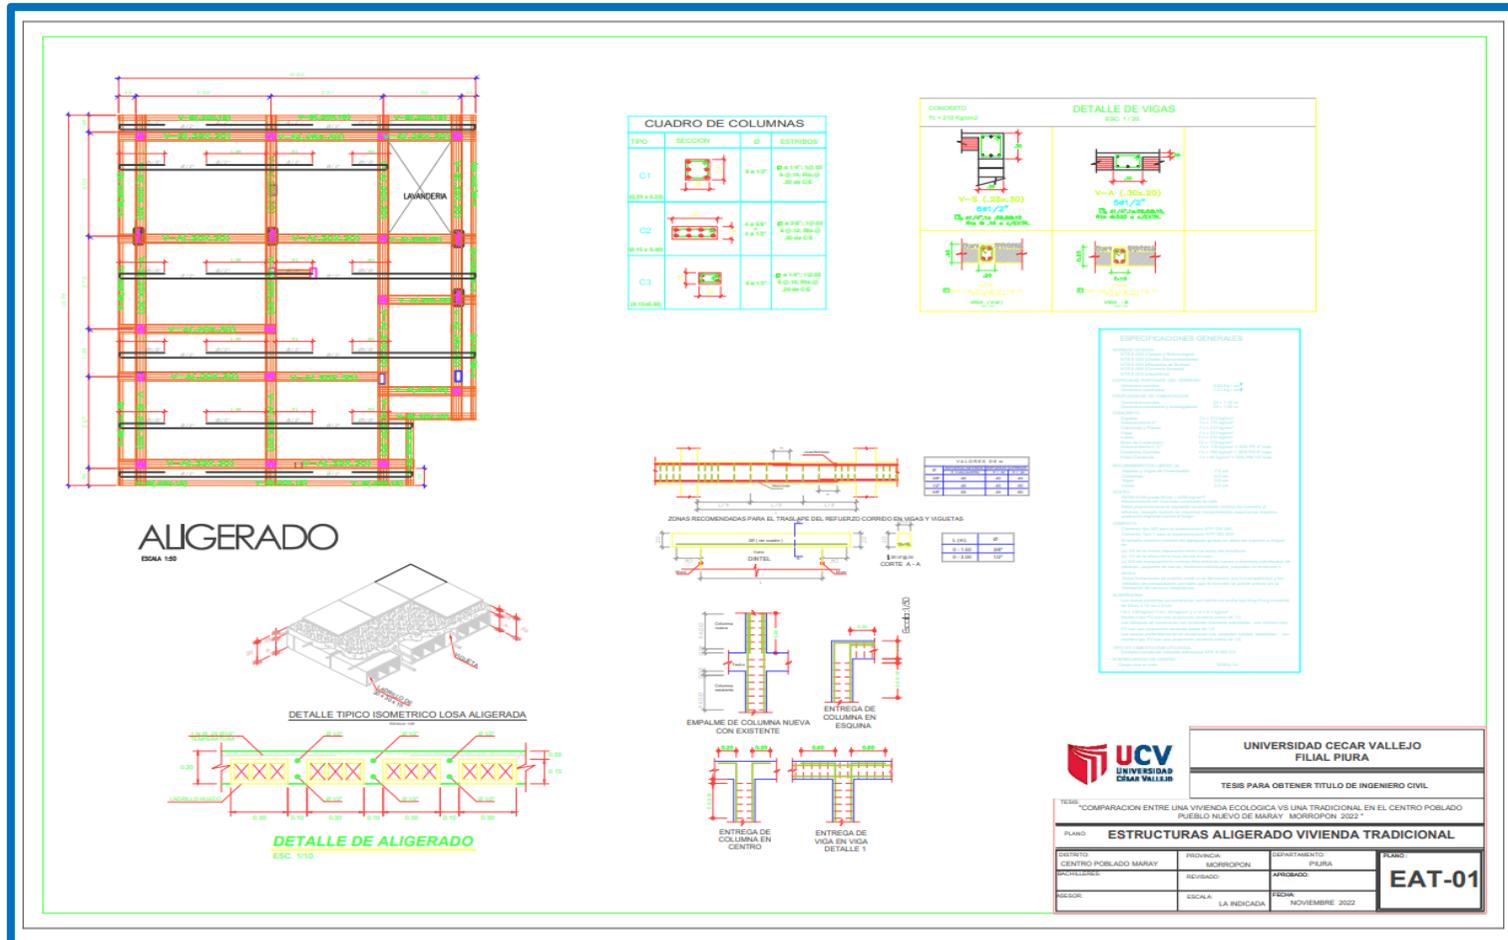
Plano de estructuras aligerado – vivienda tradicional (EAT – 01)
